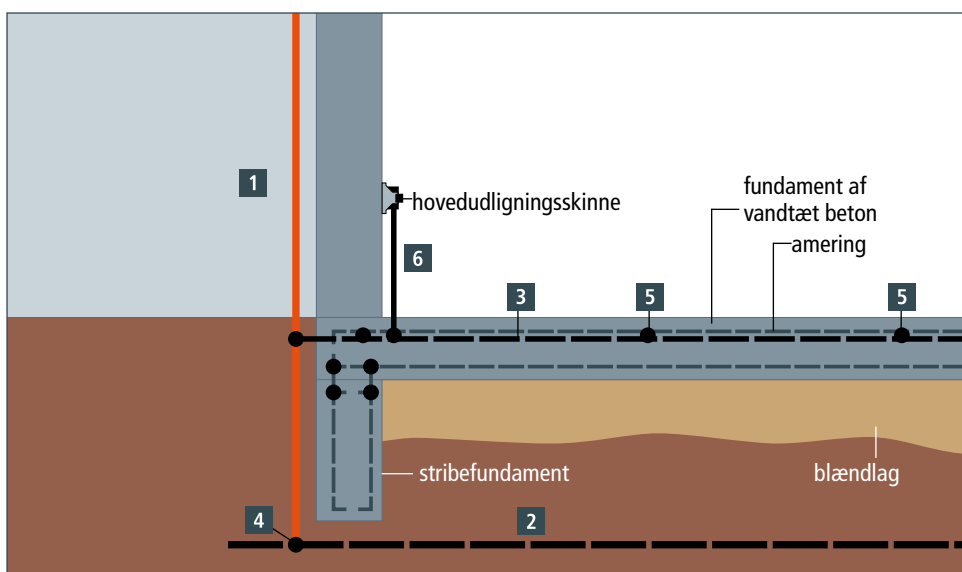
Installationseksempel i tilfælde af en vandtæt betonkonstruktion (i henhold til DIN 18014).
